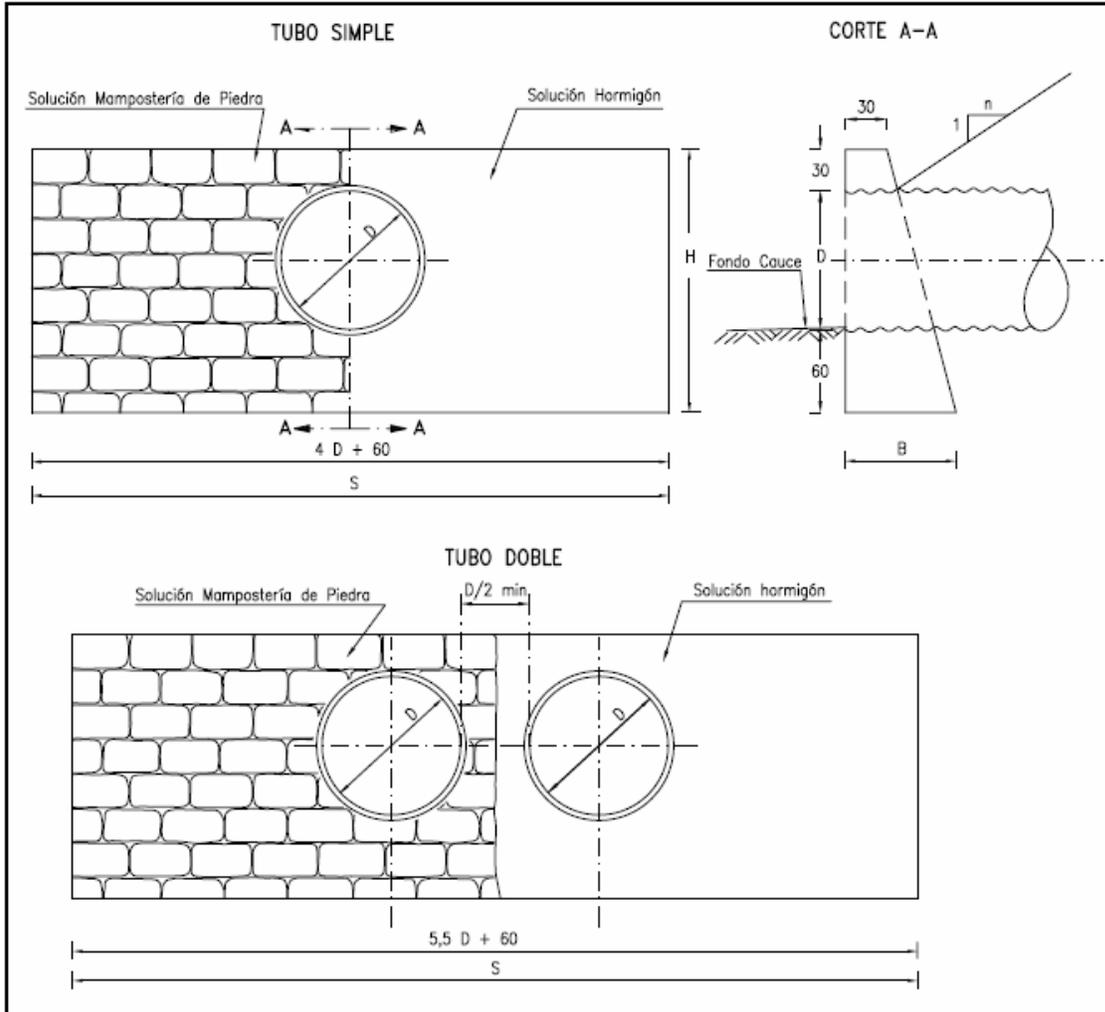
Muro de Boca para Tubos de Acero Corrugado.
